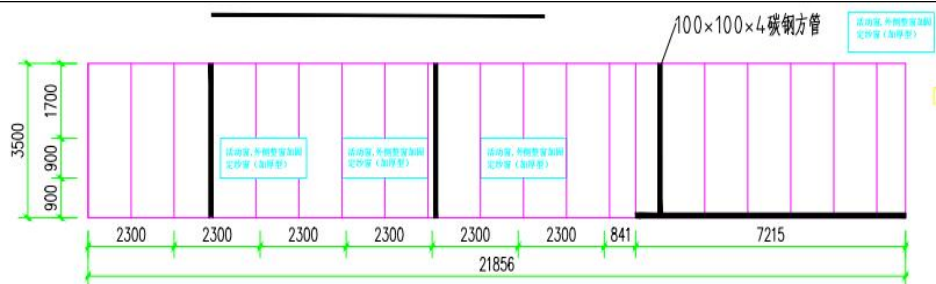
12-16 轴 5-8.5 米隔墙立面图
